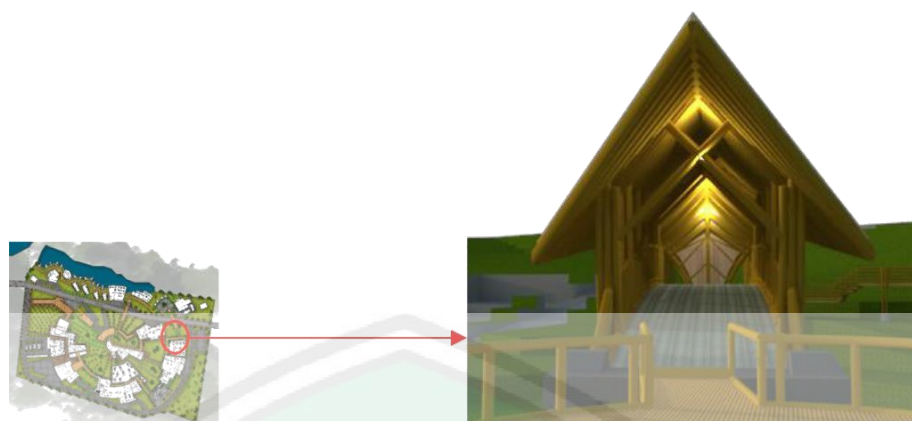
45. Detail Lanskap (Sumber: hasil rancangan, 2018)
